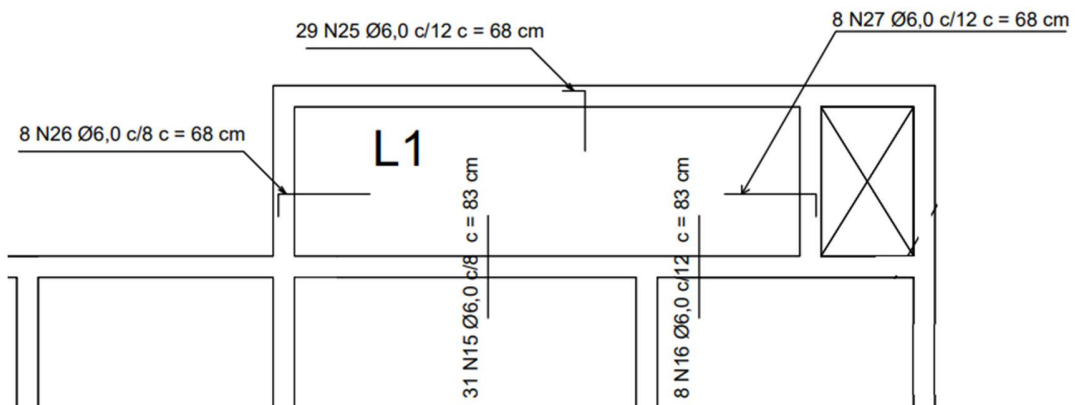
Croqui armadura negativa entre as lajes L1-L5 e L1-L6 e armaduras negativas de borda da laje L1
